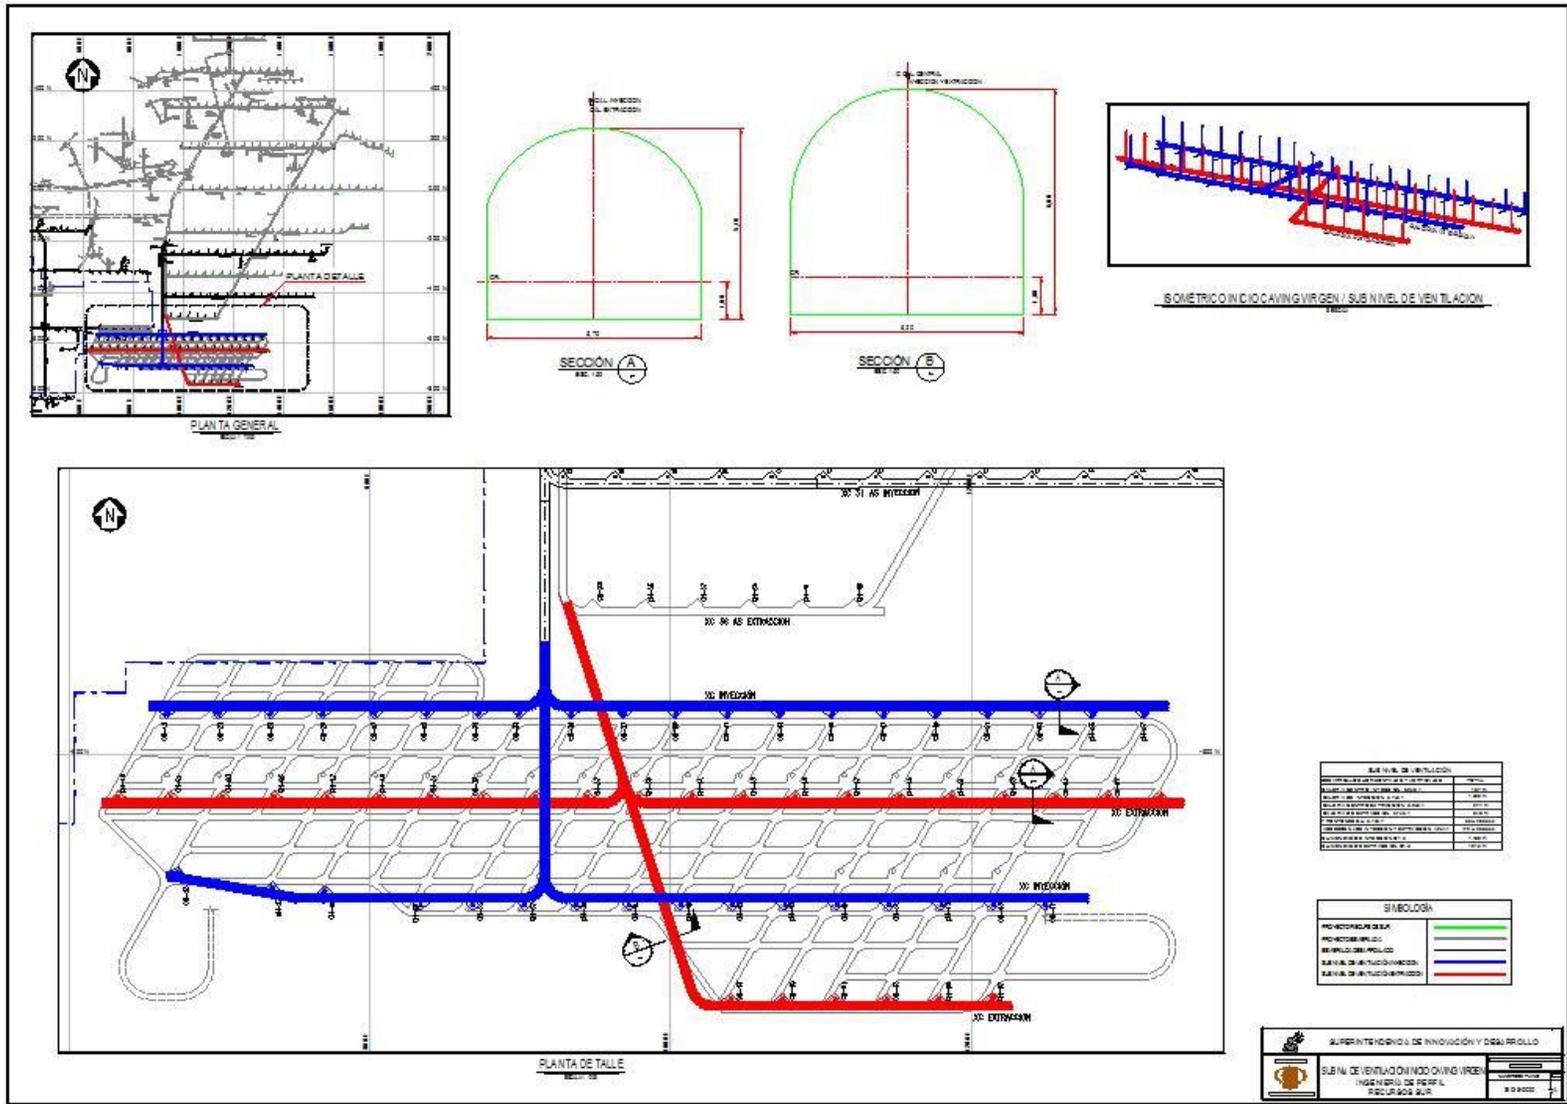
Planos Subnivel de Ventilación Caving Virgen
